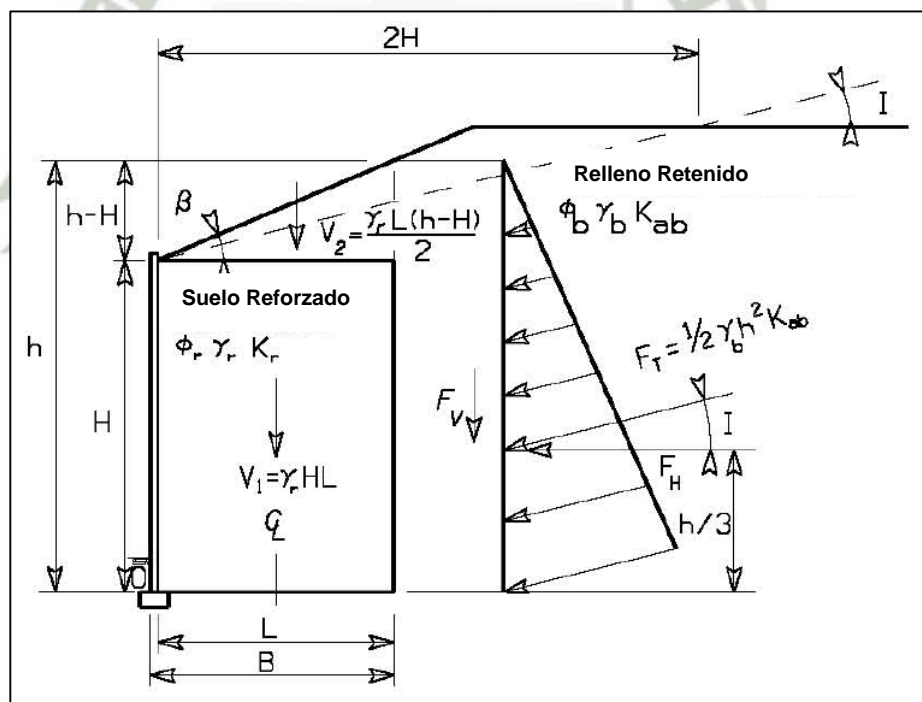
Fuerzas Actuantes en un Muro con Talud Quebrado (FHWA-NHI-10-024, 2009)
